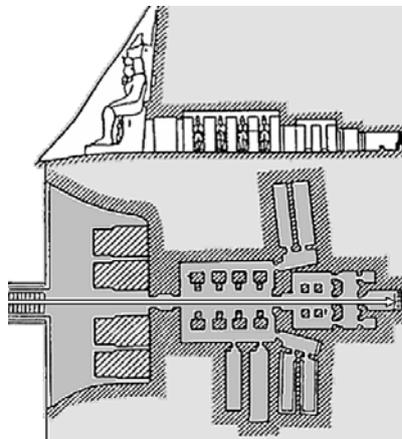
Вертикальный разрез и план храма Абу-Симбел.
